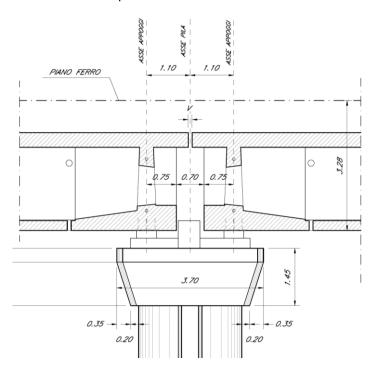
Pila, prospetto longitudinale - Due impalcati CAP
